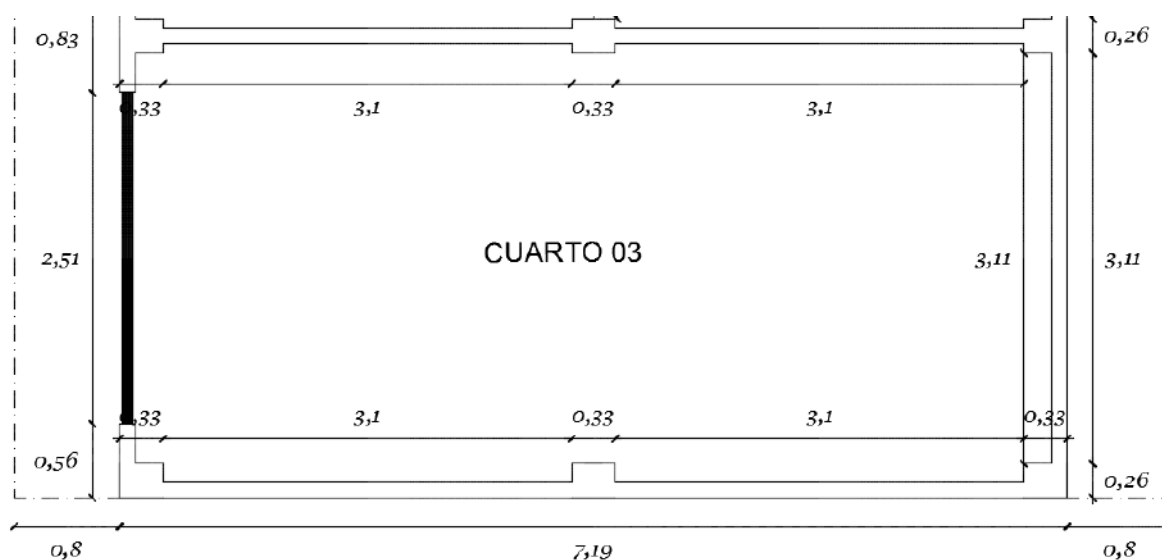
Plano en planta de la sección de vivienda en evaluación
